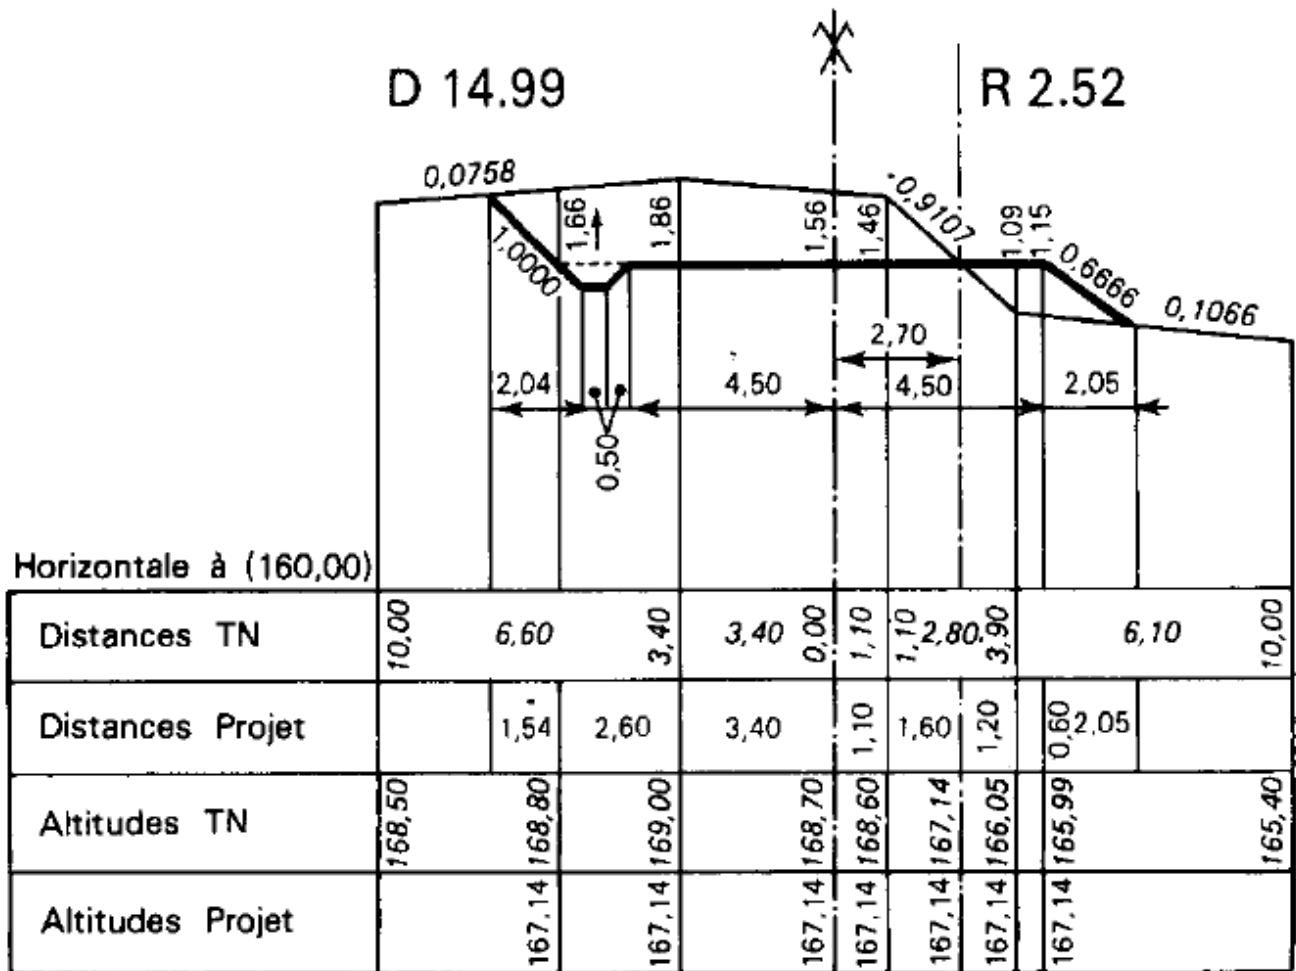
Terrassements selon le profil en travers d'un projet routier.
